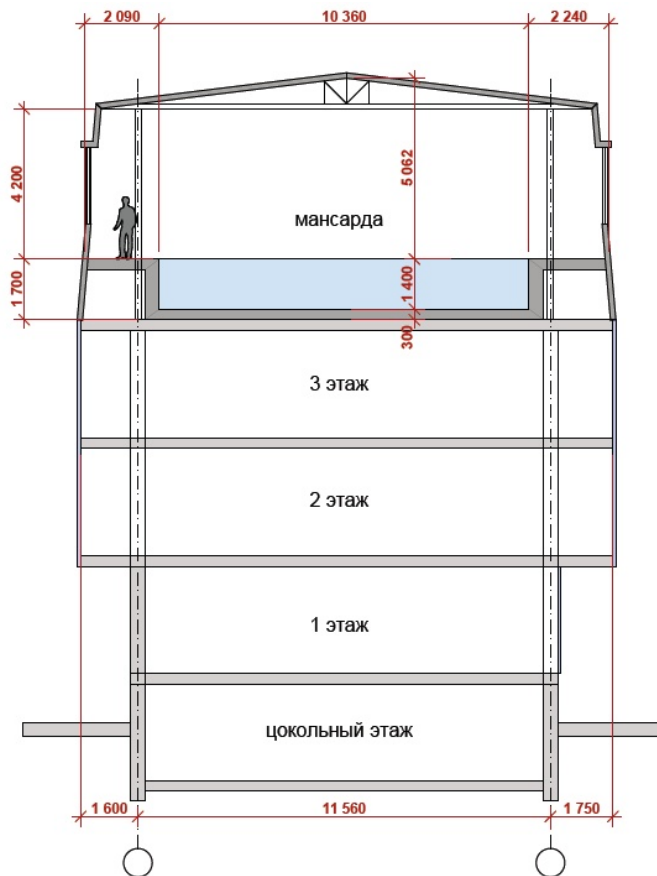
Поперечный разрез здания після реконструкції
